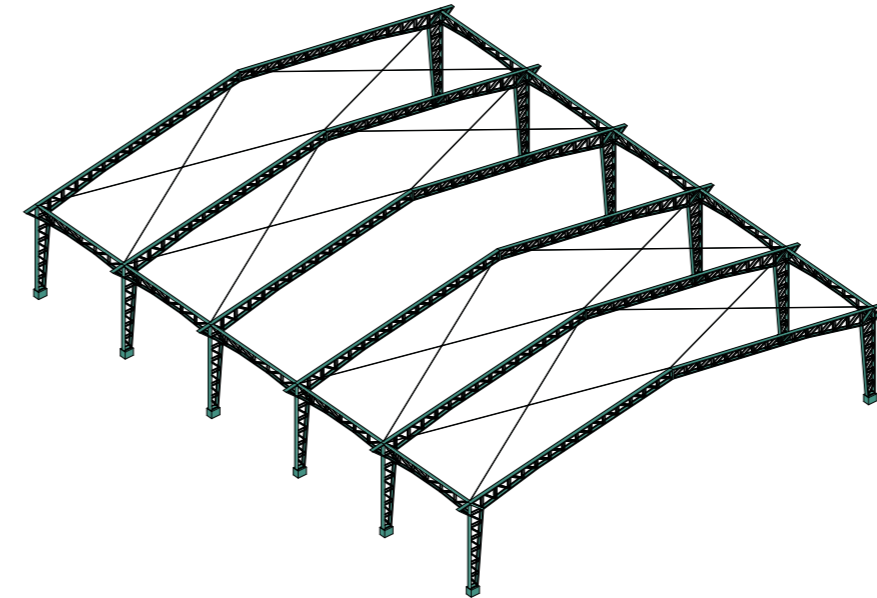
Estructura actual de la planta de desechos. Fuente: Autoría propia.
